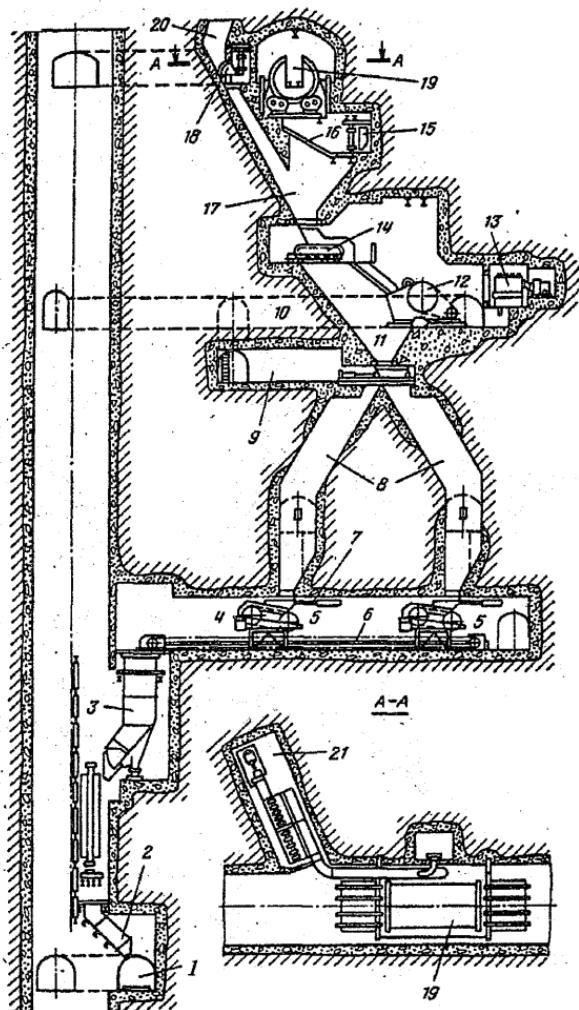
Комплекс камер, дробильно-бункерных камер и загружочного устройства:
